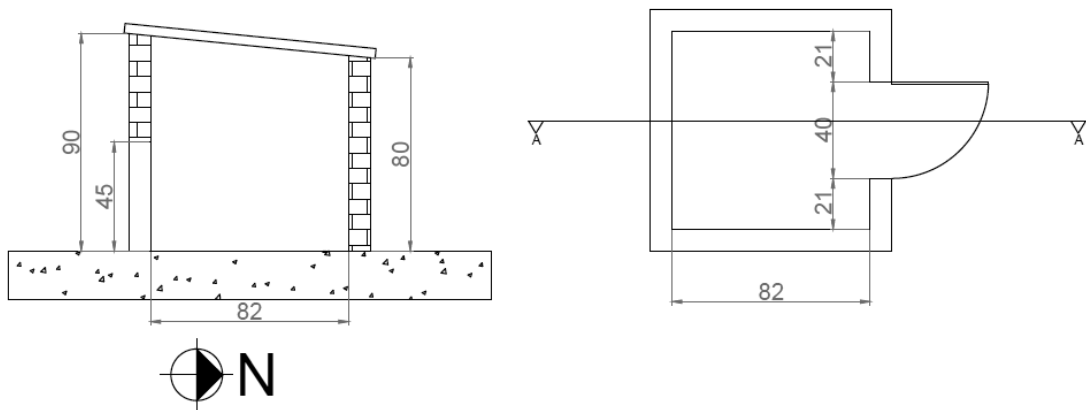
Planta baixa e corte esquemático do protótipo (unidades em centímetros)
